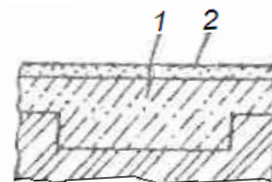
Ленточный бетонный фундамент (1); чистый пол (2)
